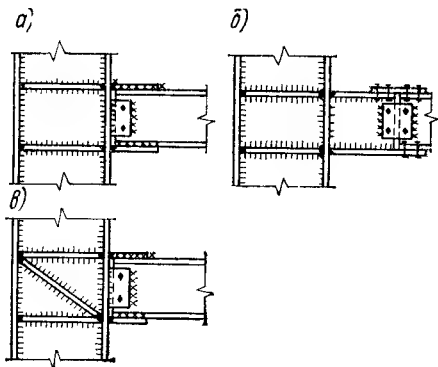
Рамные (жесткие) узлы крепления балок к колоннам двутаврового сечения
